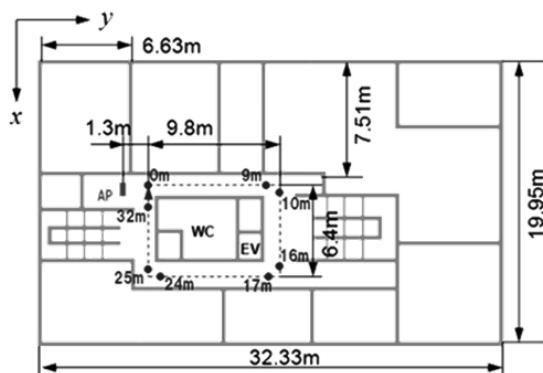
情報基盤センター北館3階平面図、AP設置位置および測定経路
